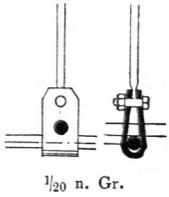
<sup>287)</sup> stellt ein solches Zeldach über nahezu quadratischem Lichthofe dar; an der Dach-Construction ist das innere Deckenlicht aufgehängt.
